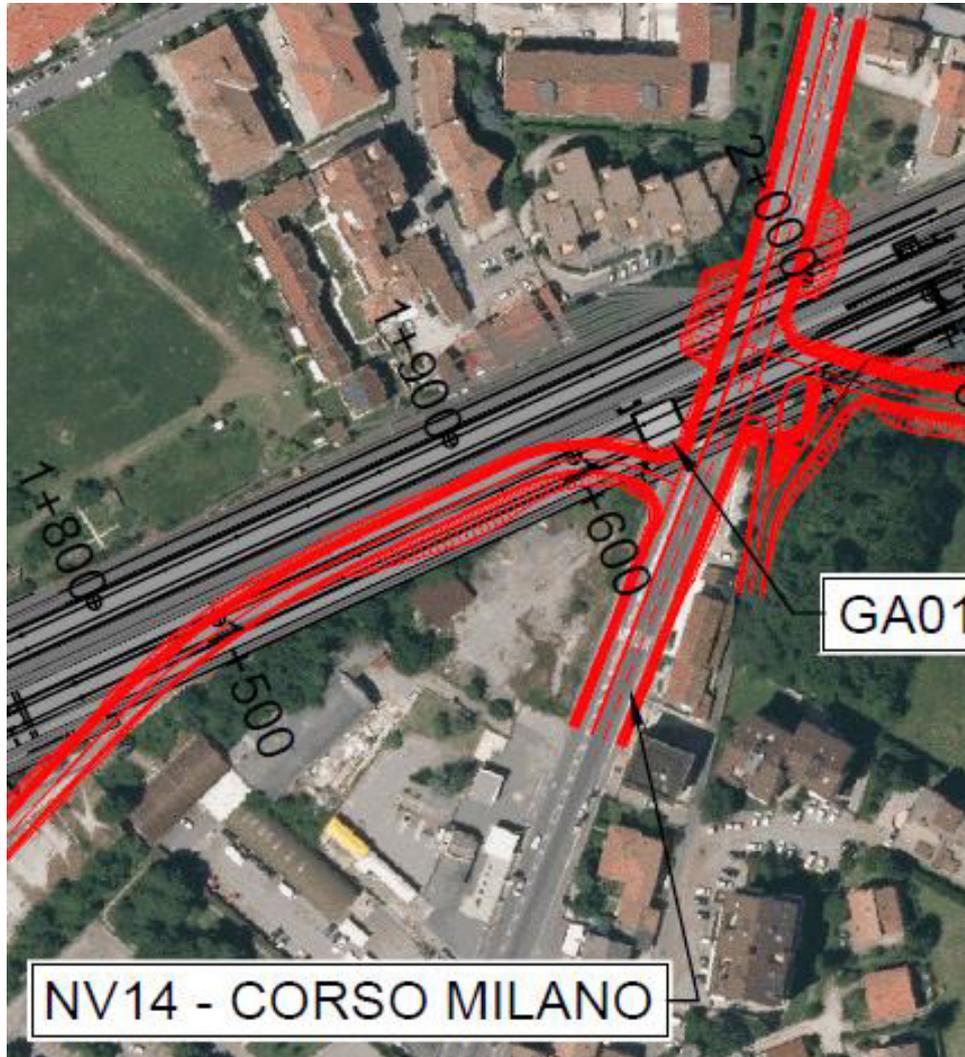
NV14 – Stralcio planimetrico su ortofoto di Corso Milano
